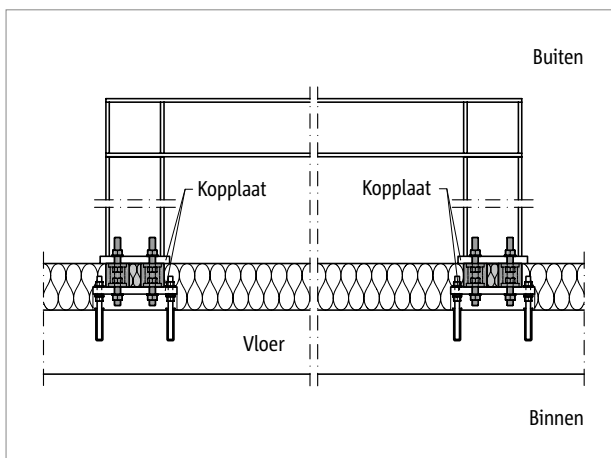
Schöck Isokorb® T type S-N en T type S-V: achteraf gemonteerde, vrij uitkragende staalconstructie; meer renovatievoorbeelden zie pag. 101
